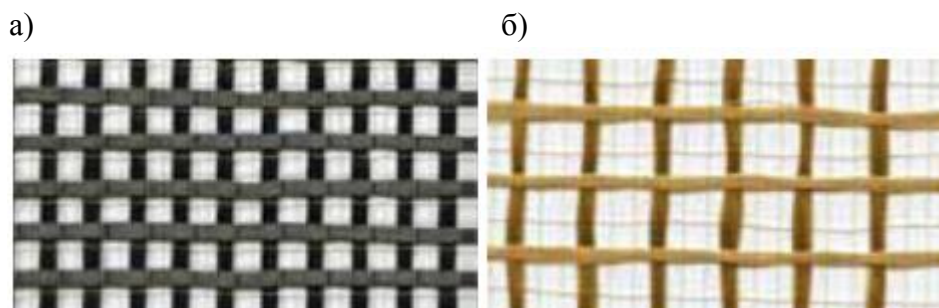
Арматурные сетки Ruredil XMech 10 (а) и Ruregold Muratura XR (б) из композитных материалов для армирования поверхностей каменных стен [37]
